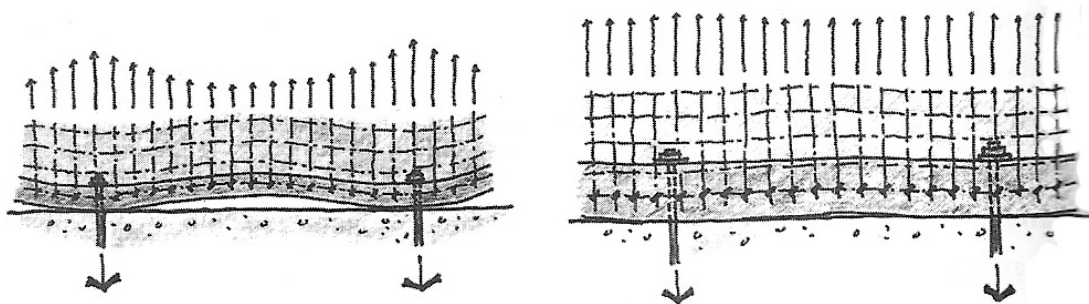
Formas de fijación de la malla metálica en la base del muro [Bruce King con Kevin Donahue, op.cit.]
